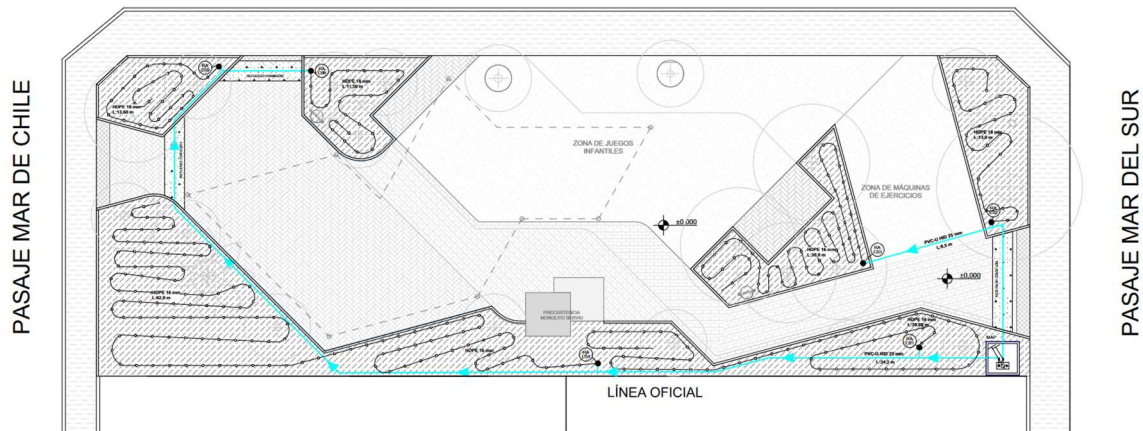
Planta sistema de riego por goteo Plaza Interior. Fuente: Municipalidad de Conchalí.
